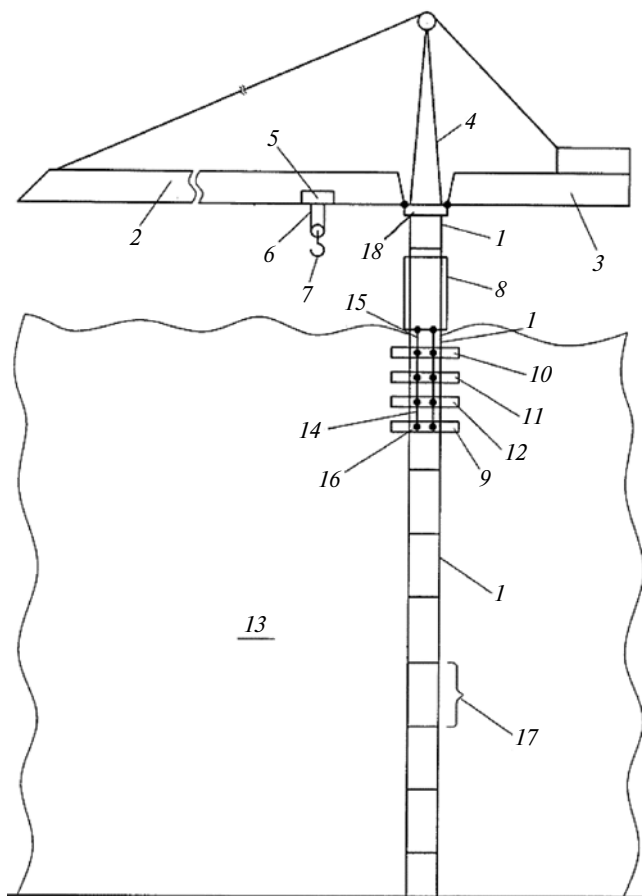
Приставной башенный кран: 1 – башня; 2 – стрела крана; 3 – противовесная консоль; 4 – оголовок; 5 – грузовая тележка; 6 – грузовой канат; 7 – грузовой крюк; 8 – монтажная обойма; 9, 10, 11, 12 – рамы для соединения башни крана со зданием; 13 – здание с жестко закрепленным несущим элементом и средствами фиксации; 14 – конец тяги (шарнирно связан с соответствующей рамой съёмными пальцами); 15 – тяга (шарнирно связана с соответствующей рамой съёмными пальцами); 16 – съёмные пальцы; 17 – соединенные между собой секции; 18 – опорно-поворотное устройство
